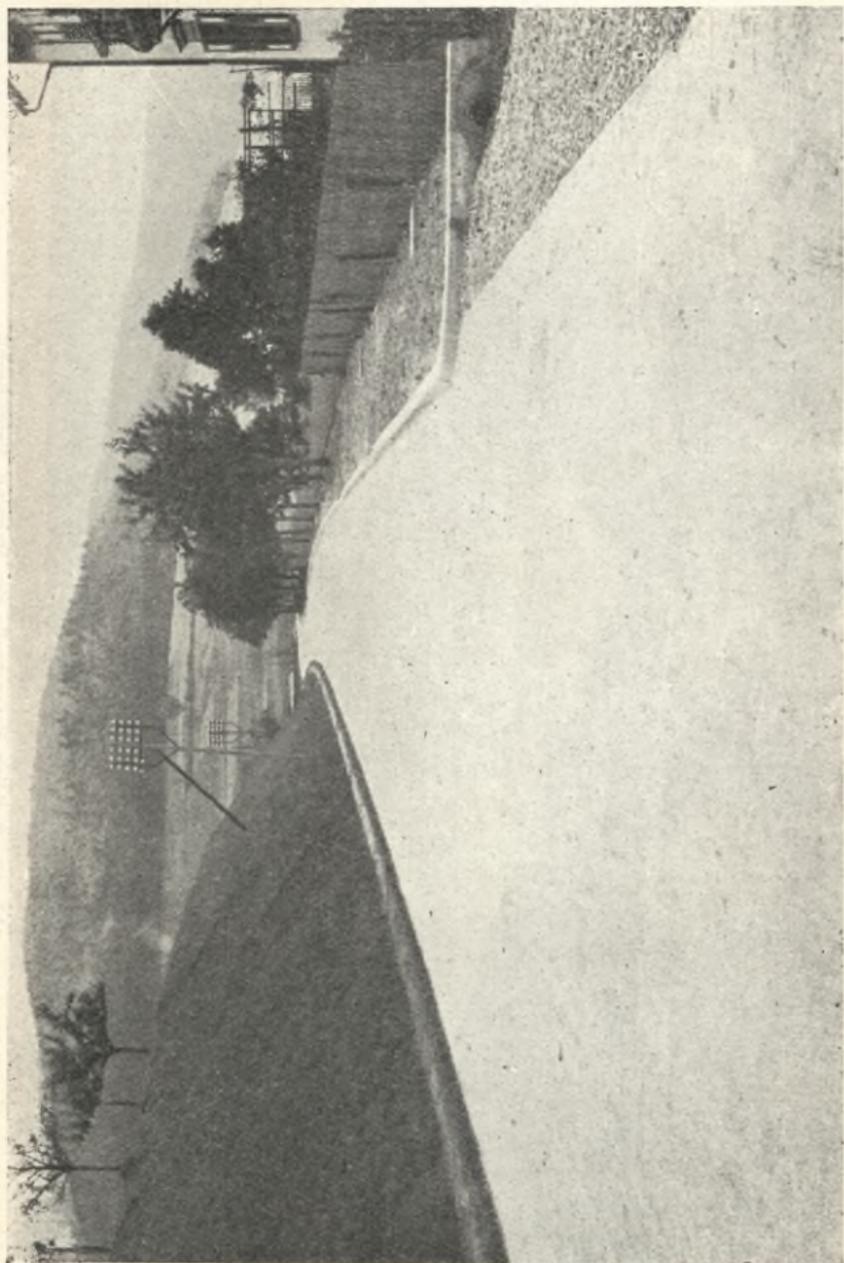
Solidit-Betonstraße am Bahnhof Bayersbrunn.
